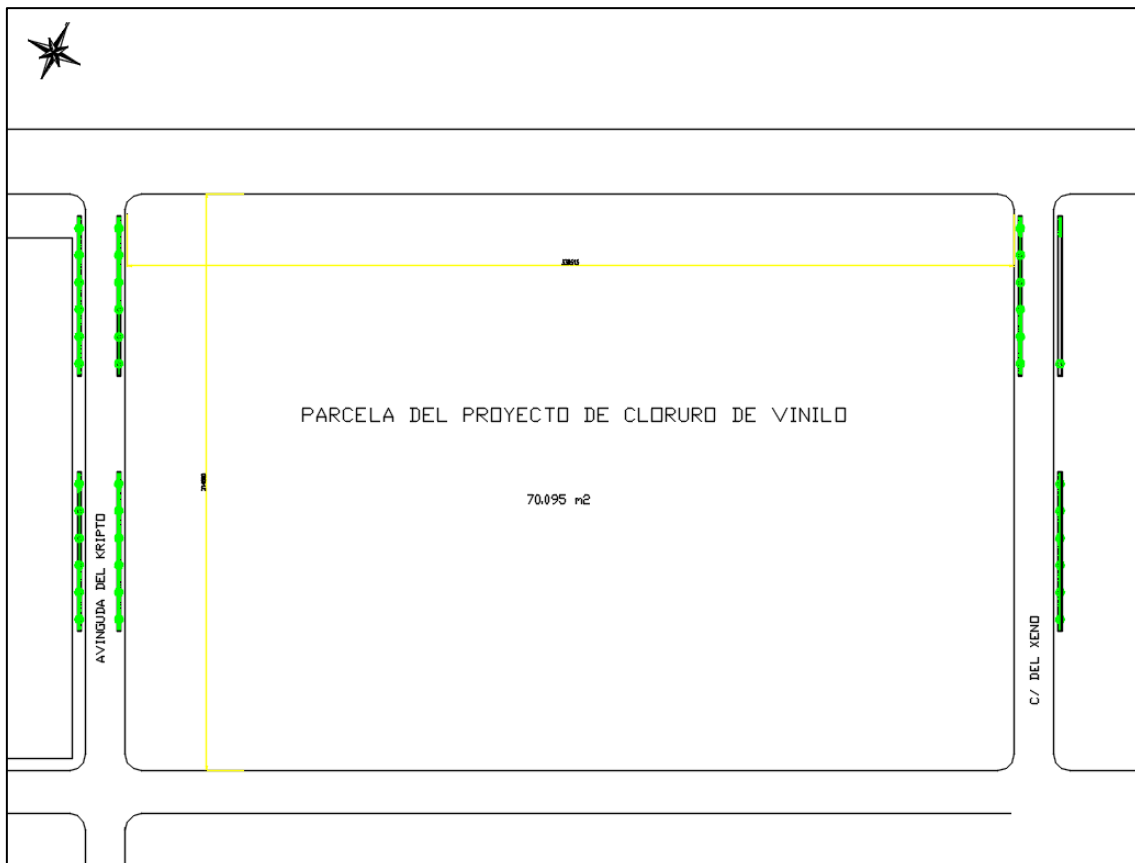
Plano de la parcela donde se ubicará la planta de producción de cloruro de vinilo.
